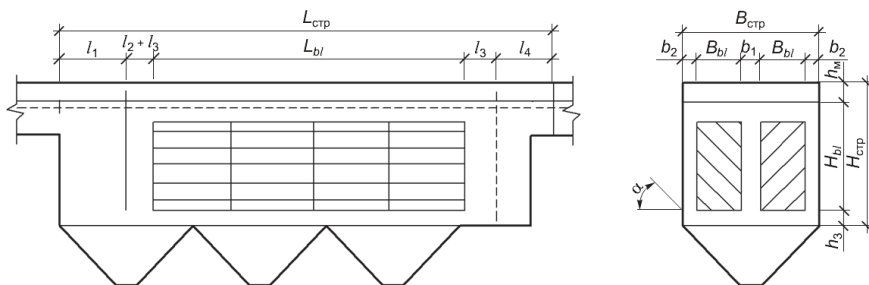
Расчетная схема тонкослойного отстойника с перекрестной схемой работы
